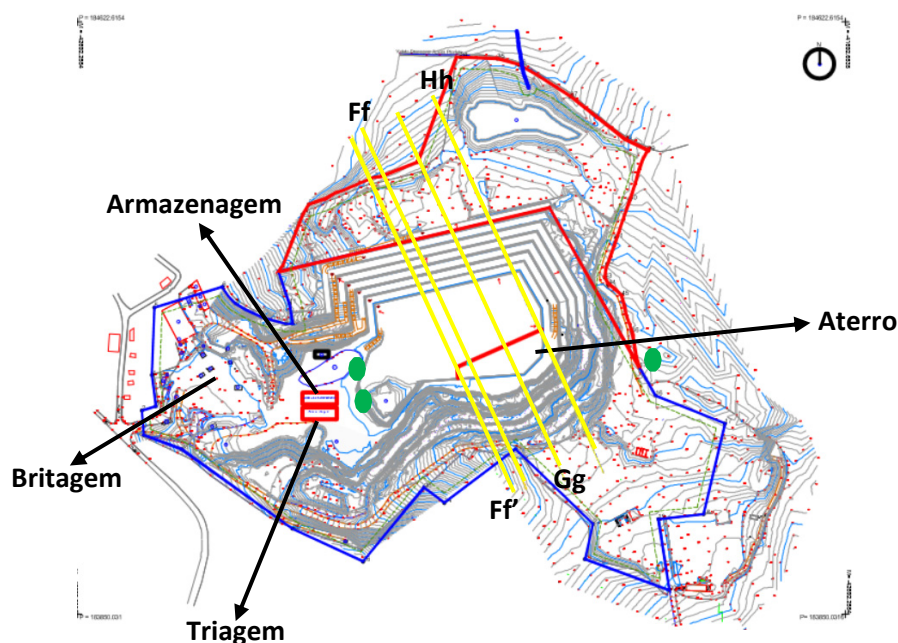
Planta de localização da pedreira "Vila Verde nº2" (adaptado de Cevalor *in* PARP)
